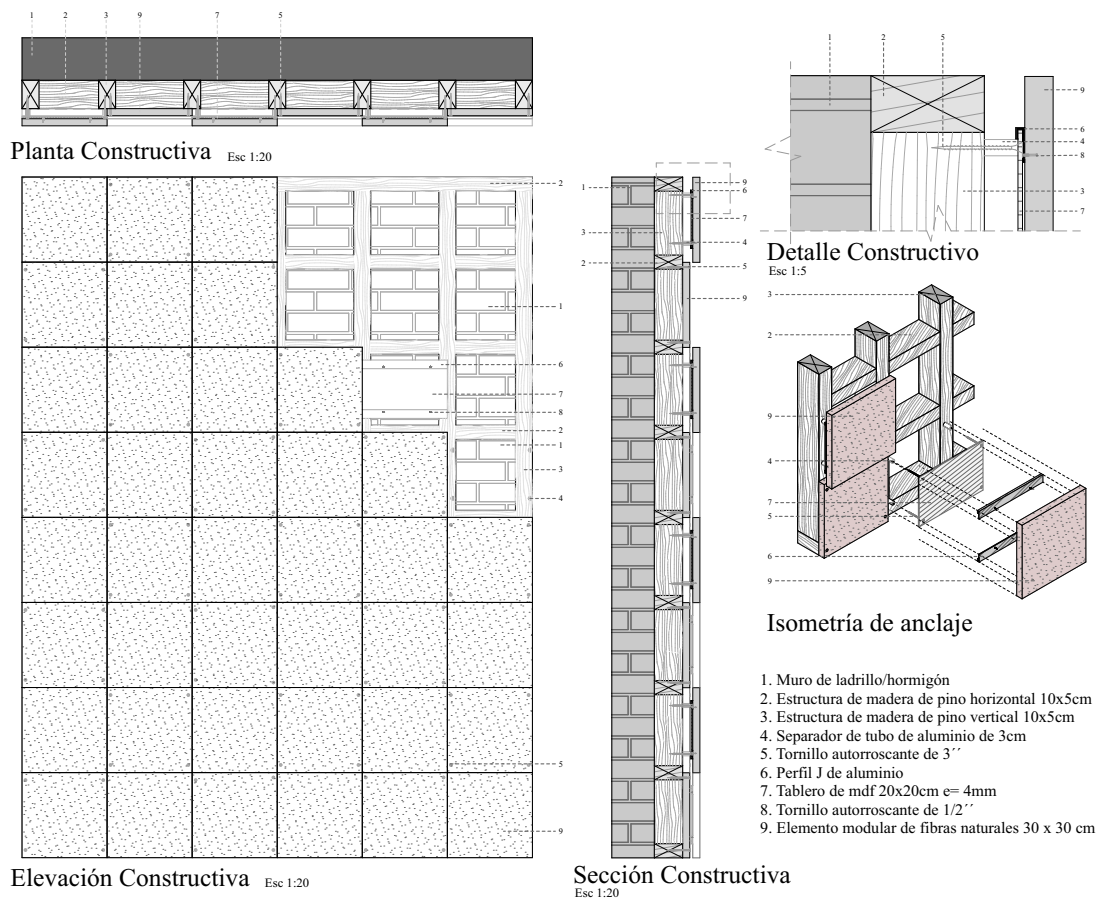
Detalle constructivo para recubrimiento de muro diseño 1. Fuente: autor
